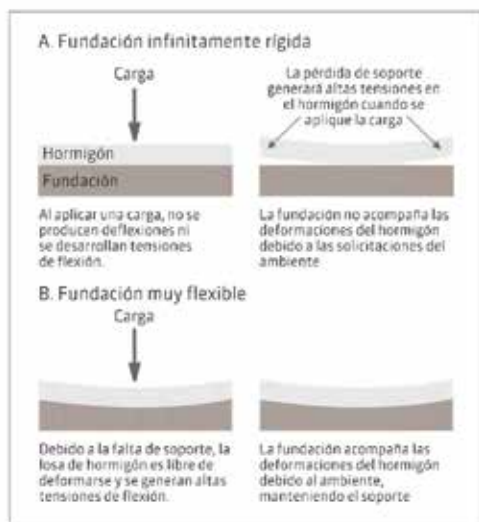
Análisis conceptual de la influencia de la rigidez del soporte sobre las cargas aplicadas y los efectos del ambiente en el pavimento de hormigón.
